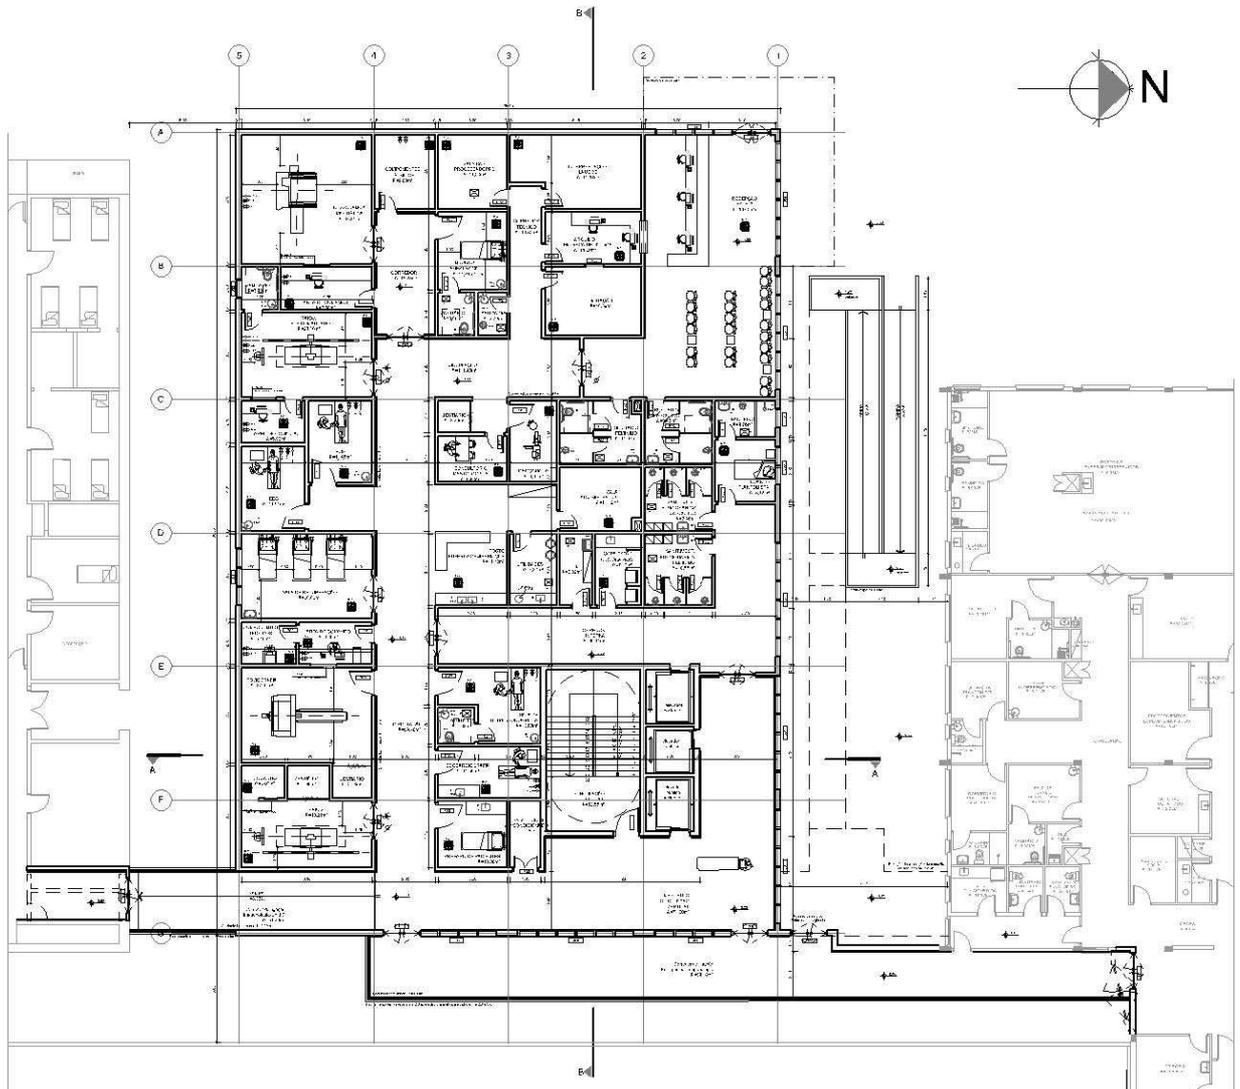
Planta-baixa do primeiro pavimento
